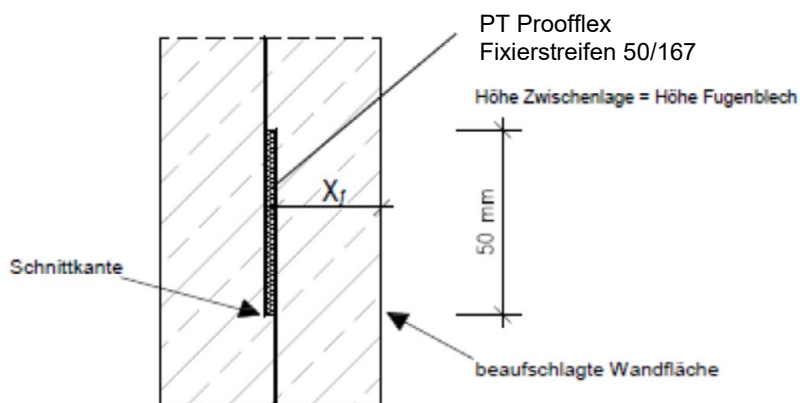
wie Bild 1 + Ausrichtung der Schnittkante des bauseitig angepassten Fugenblechs zur nicht beaufschlagten Seite
